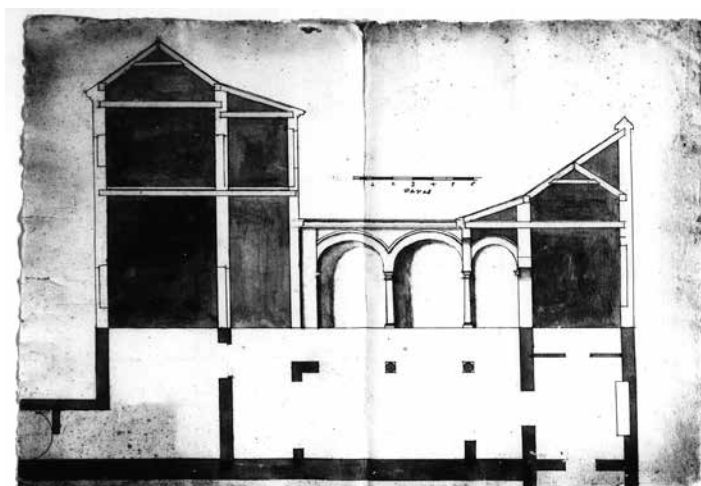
B. Planta y sección de una galería. AGAS. Leg. 12. Expediente 1, n.º 2 y 9b.
